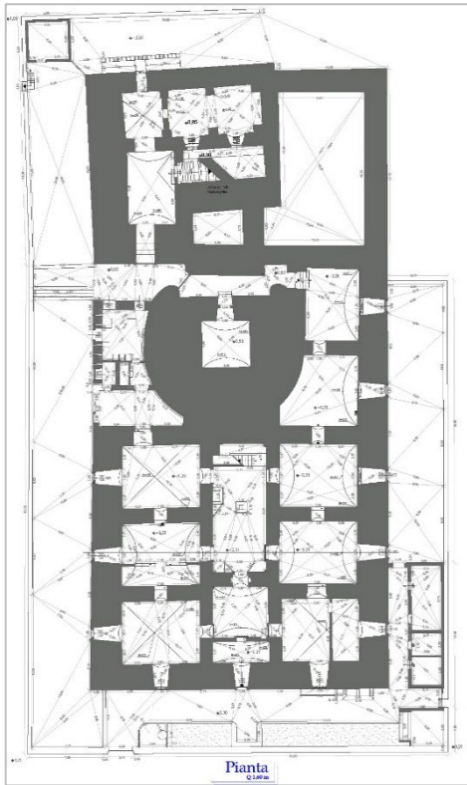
Pianta (+1,60m) del forte degli inglesi (Arena G., Tesi di laurea 2011).
